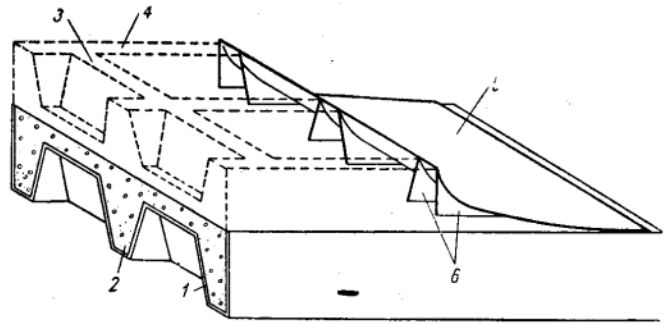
Вид плиты штампа для изделий с продольными и поперечными ребрами
